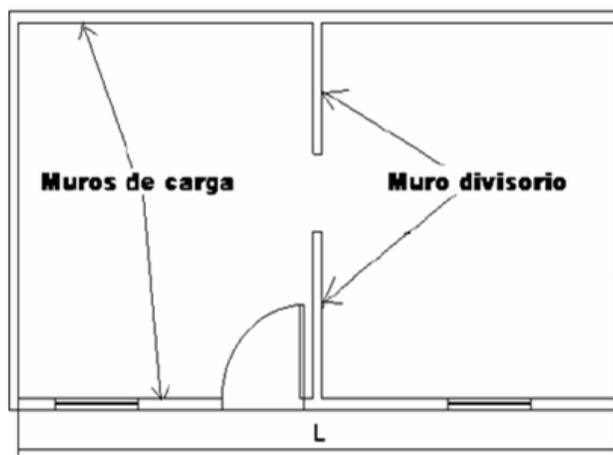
Configuración de los muros en planta de la estructura y su respectiva separación (L).
